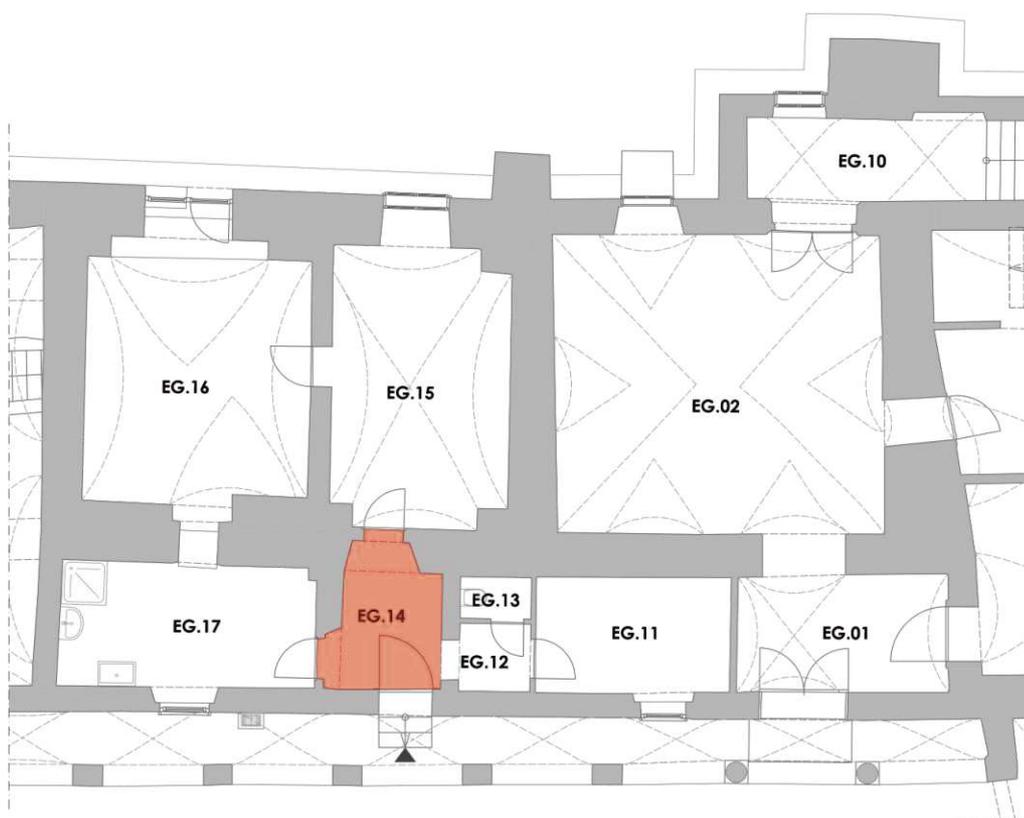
Erdgeschoss Übersichtsplan- EG.14
